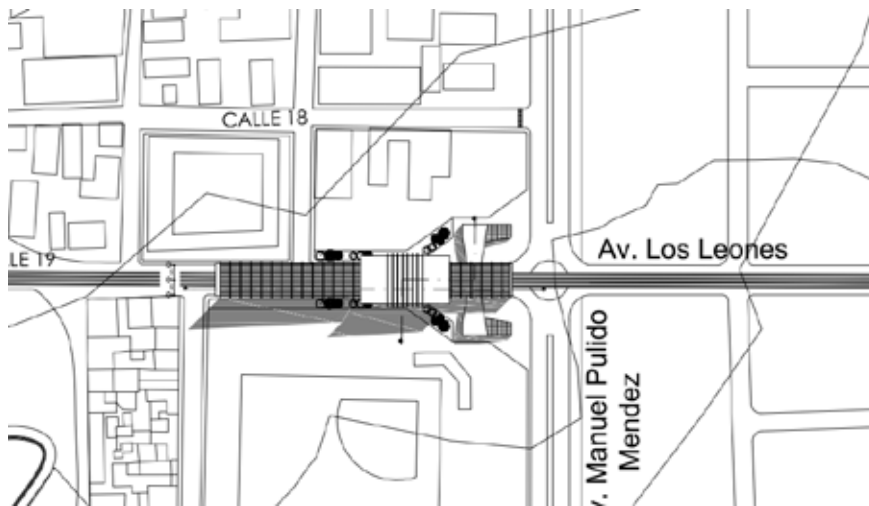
Planta Conjunto Propuesta Estación Tipo en la Ciudad de Rubio.
